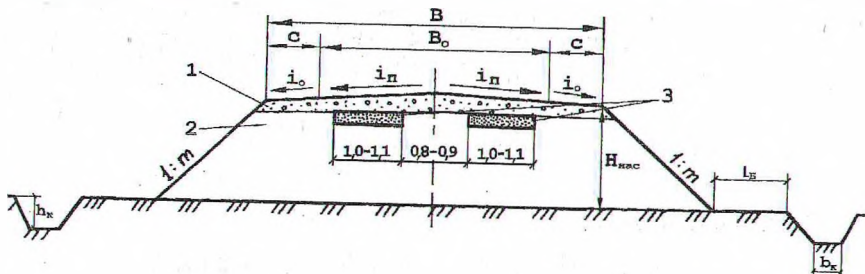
Поперечный профиль дорожной конструкции колеино-го типа:
